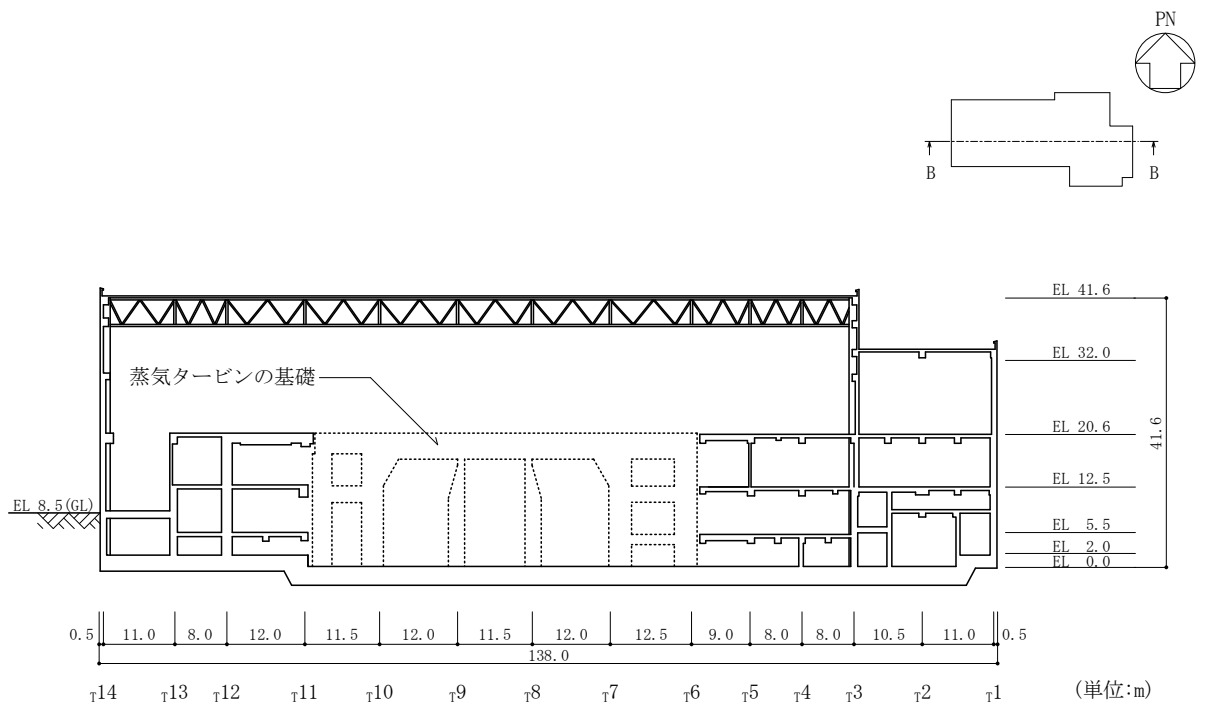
(2) タービン建物の概略断面図 (B-B 断面, E W 方向)
